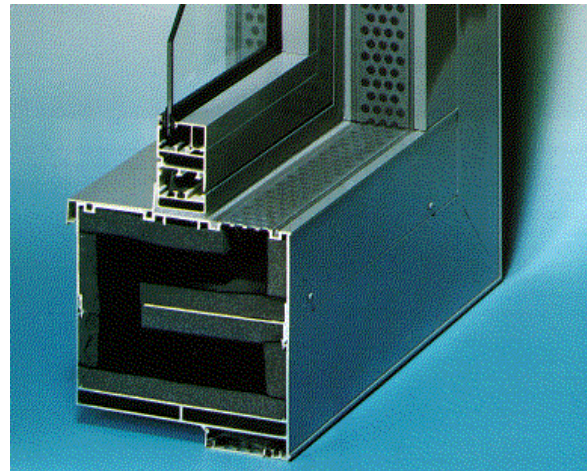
Vorsatzfenster zur Erzielung hoher Schalldämmung, mit Lochblech abgedeckte schallabsorbierende Ausstattung [9]
